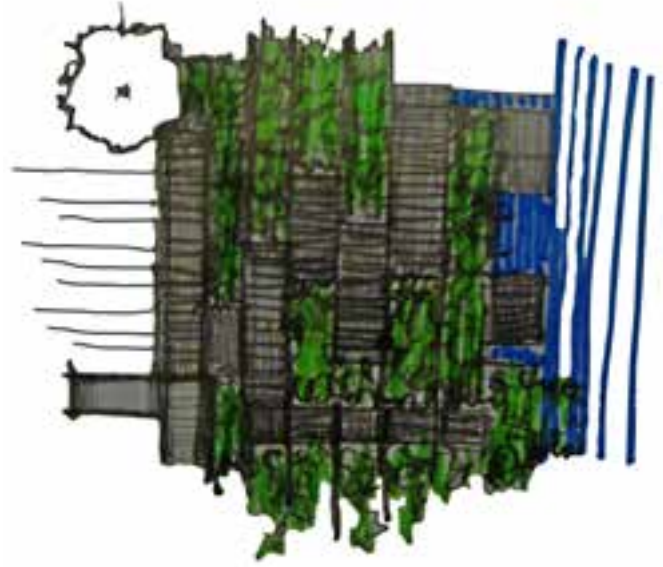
Vista en planta y corte de la plaza cultural
